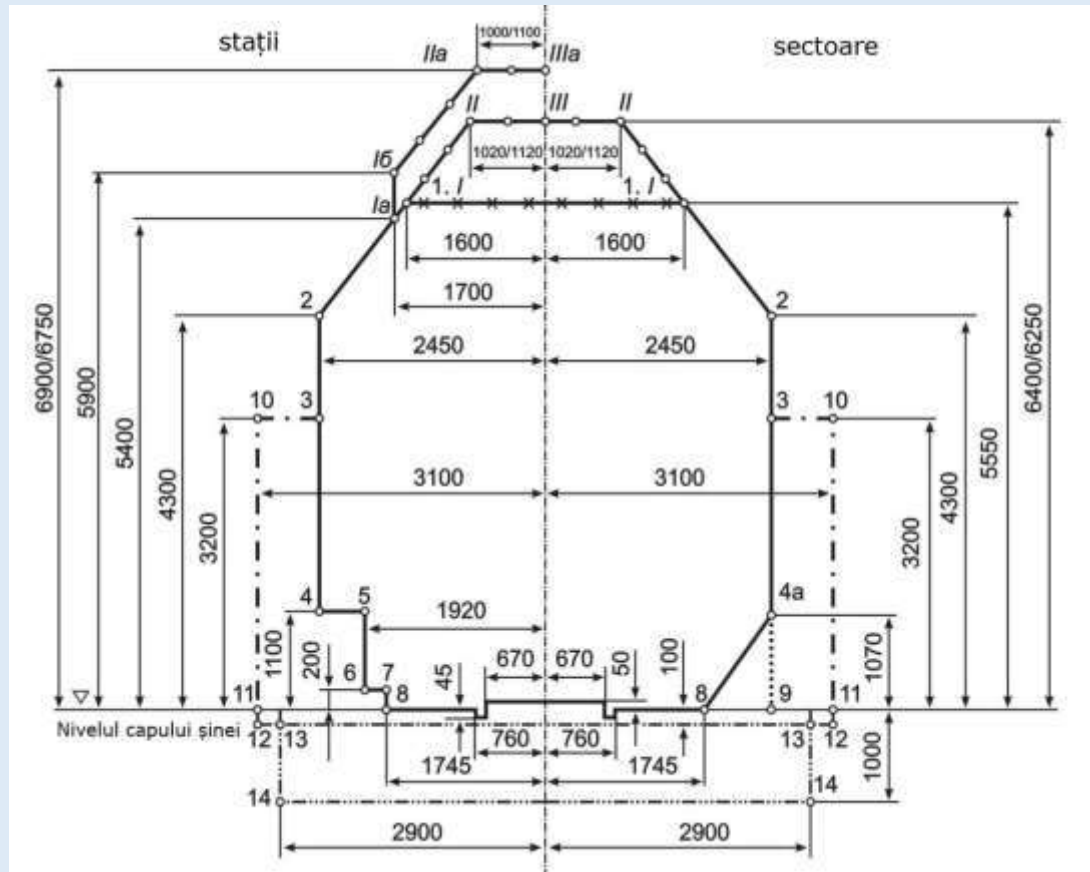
Gabaritul de apropiere al construcțiilor C
